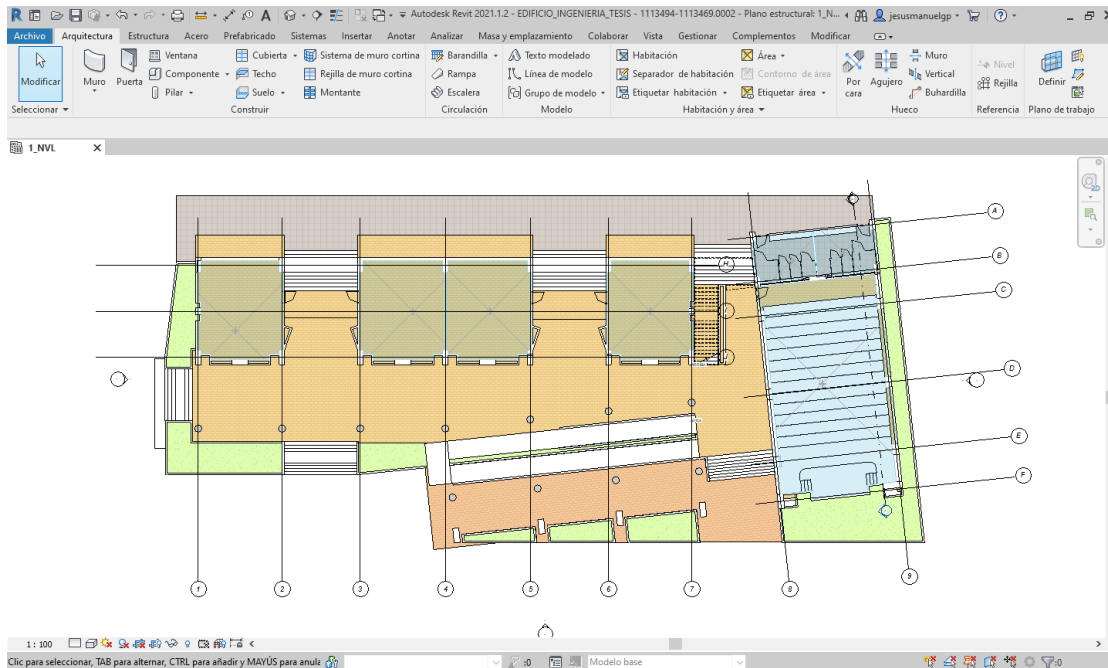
Importación de plano 2D plano estructural planta N°1 edificio aulas oriente
